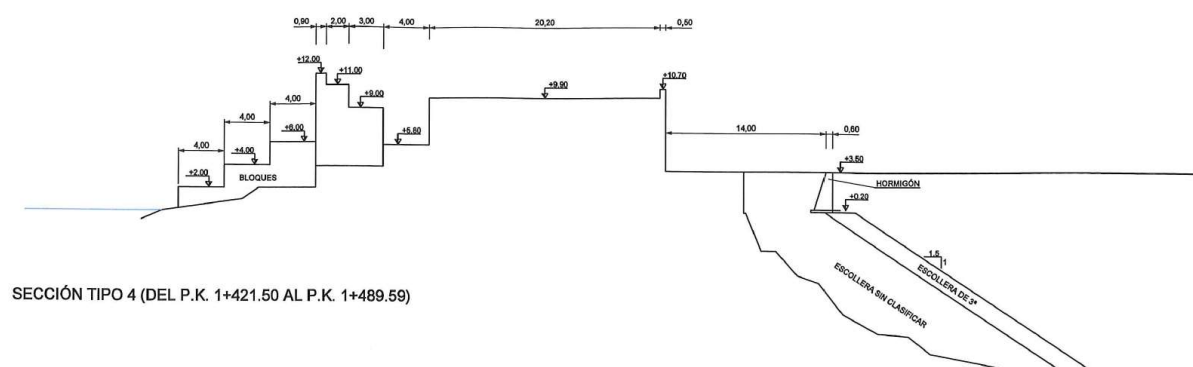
Sección tipo 4 con un manto de bloques construido por escalones.
